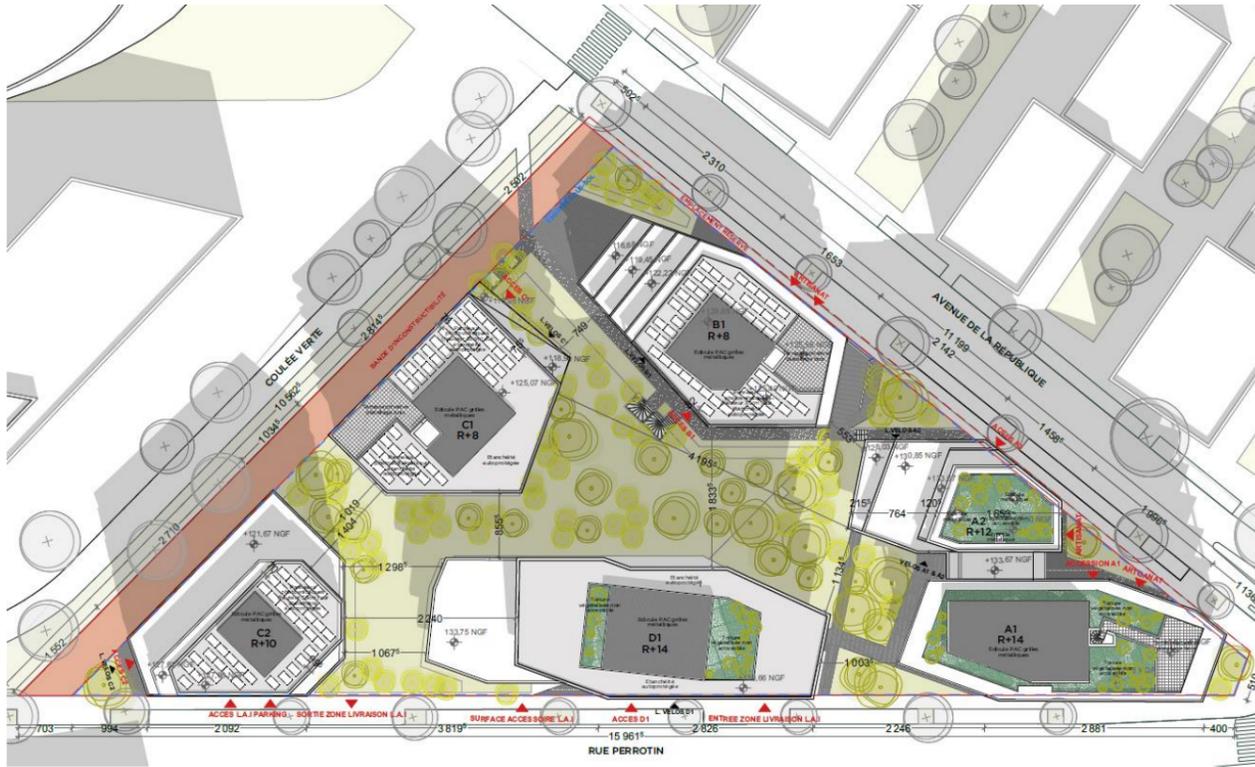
Plan masse utilisé pour modéliser le projet dans Urban Print (Source : Pièce PC 2.01 Plan de masse des constructions, permis de construire, PPX Architecture, octobre 2024)
